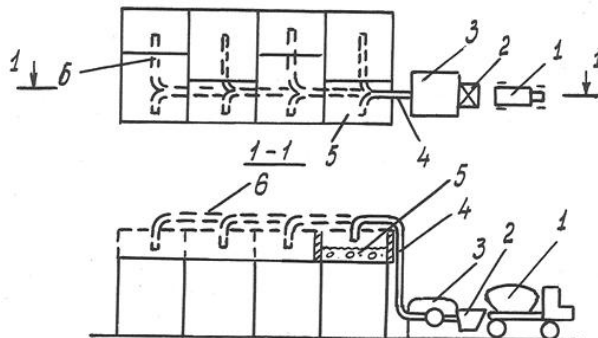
Схема подачи бетонной смеси в блоки бетононасосами:
